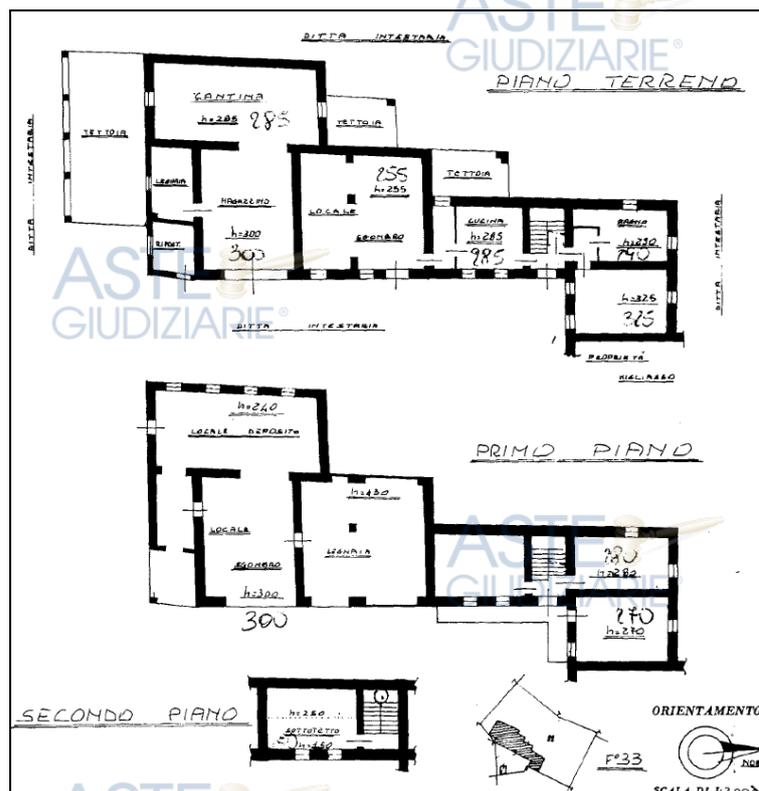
Estratto planimetria catastale (prot. n.T254871 del 05/12/1986)
